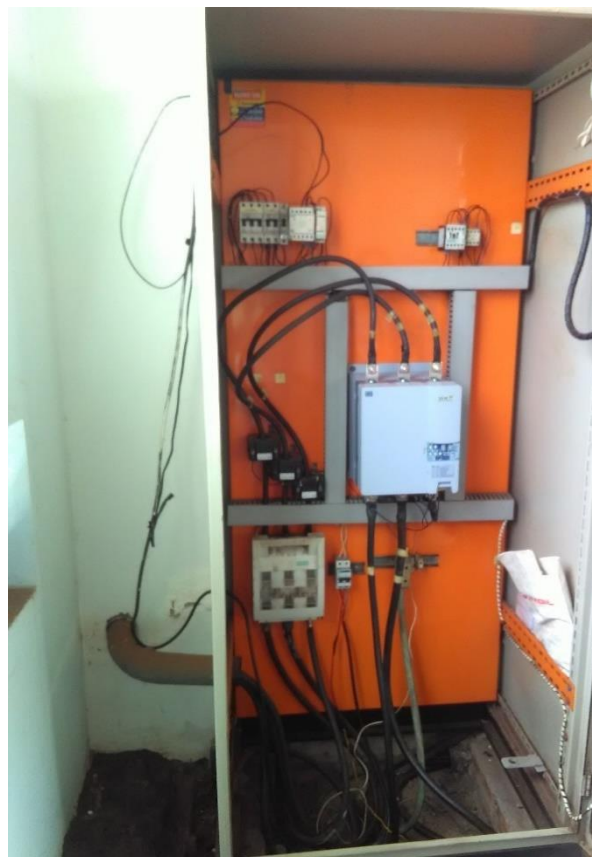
Quadro de comando da elevatória junto ao poço 02
